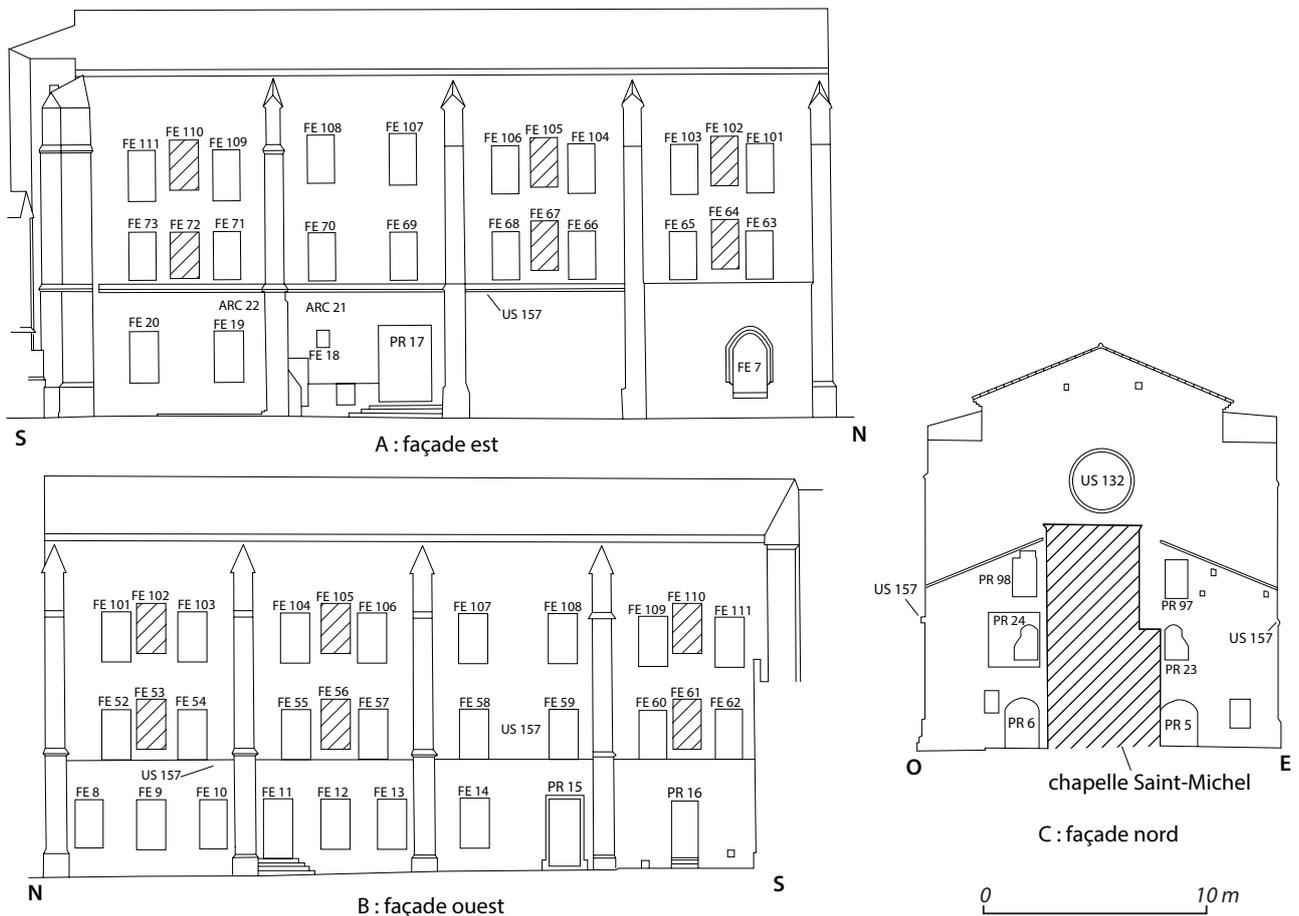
AVIGNON, 33, place des Corps-Saints. Coupe sud-nord (façade ouest), coupe ouest-est (façade nord) et coupe nord-sud de la chapelle de Pierre de Luxembourg (relevé : J. Blanc géomètre, DAO : G. Baro).
